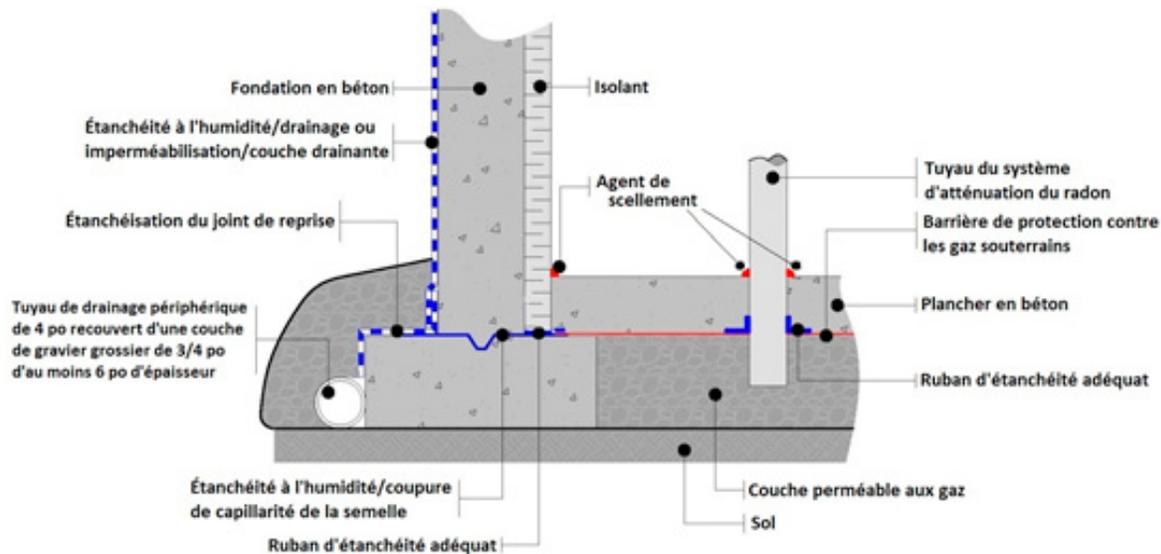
Scellement de la membrane sous la dalle à la semelle en béton avant la coulée du béton et du joint de reprise entre la dalle et le mur après la coulée du béton
